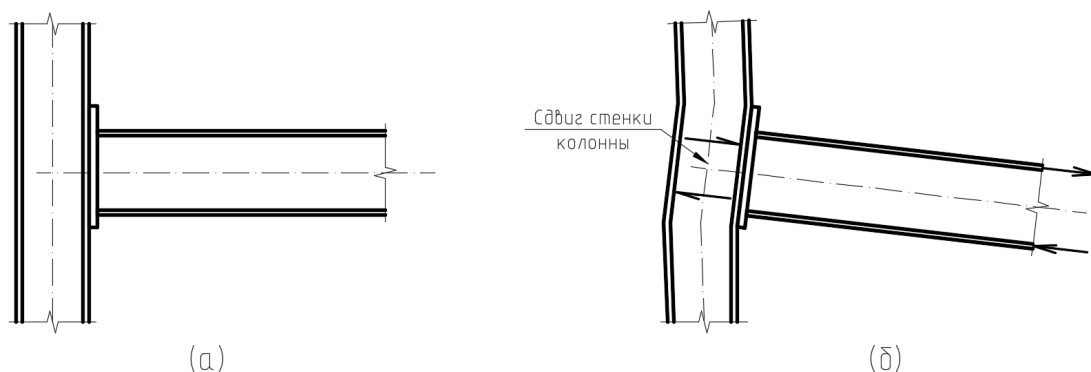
Схема работы узла колонны с односторонним примыканием балки.
